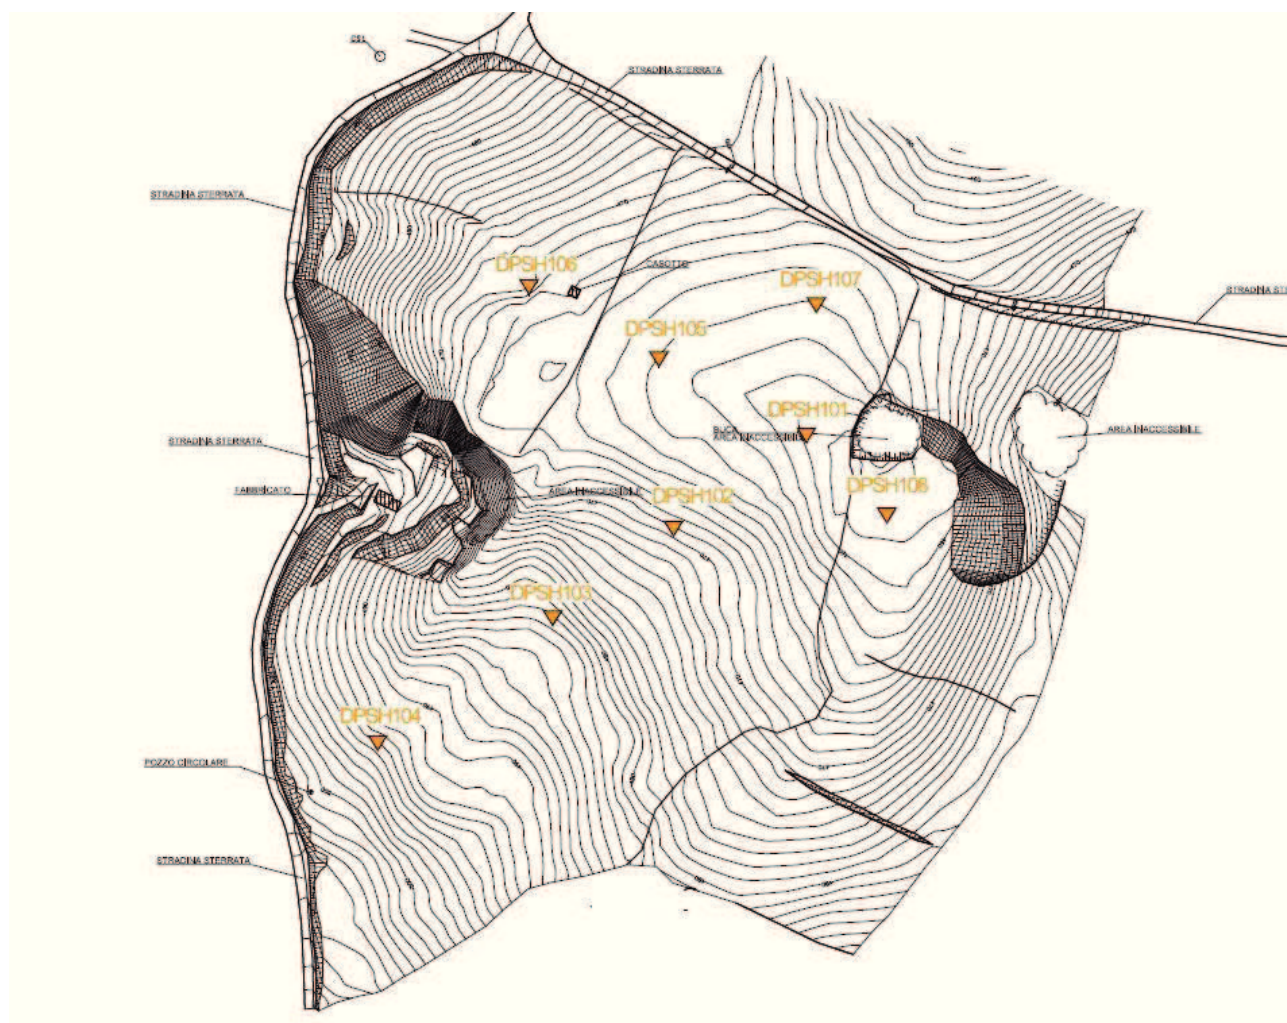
Planimetria prove penetrometriche dinamiche pesanti (DPSH).
